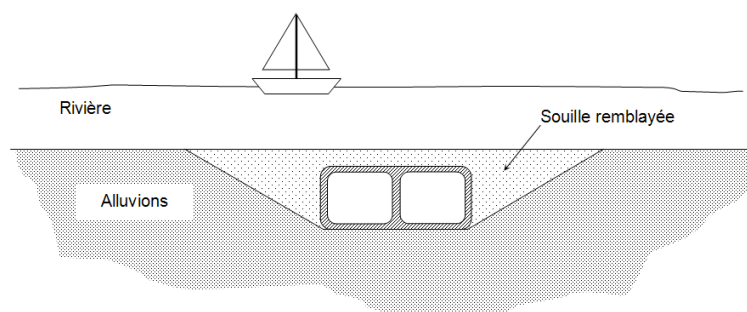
Schéma en coupe d'un tunnel immergé une fois terminé. La pose des caissons nécessite l'excavation d'une souille de largeur importante.
